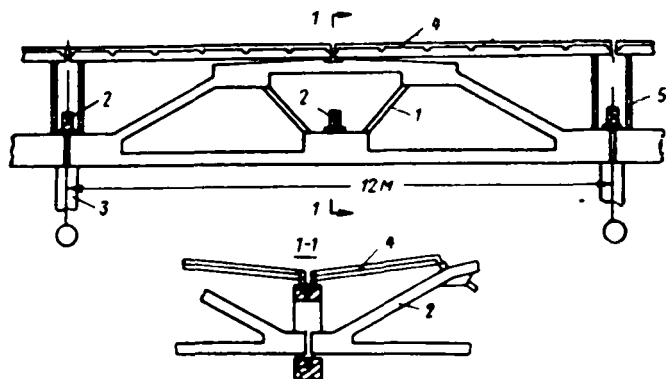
Схема сопряжения подстропильных ферм для скатной кровли с конструкциями здания
